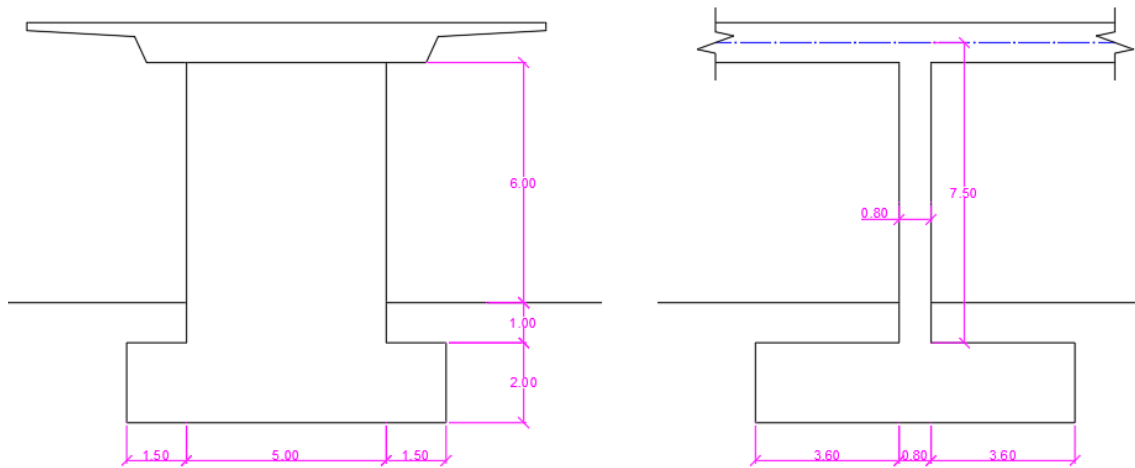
Alzado longitudinal y transversal de las columnas. Modelo 3 COL 80x500
